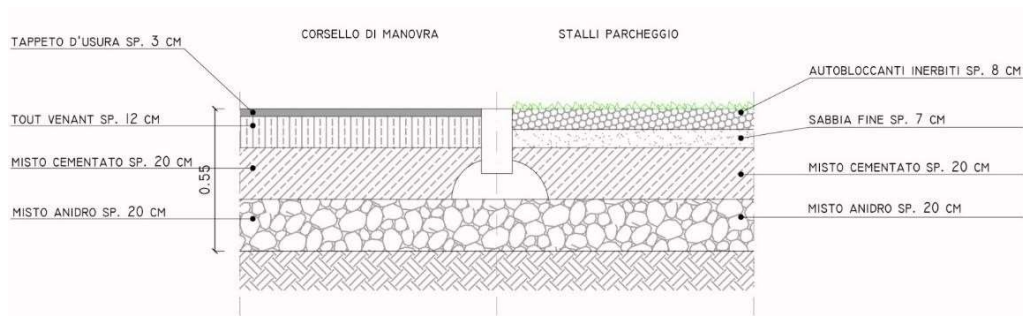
Pacchetto di pavimentazione dei parcheggi
